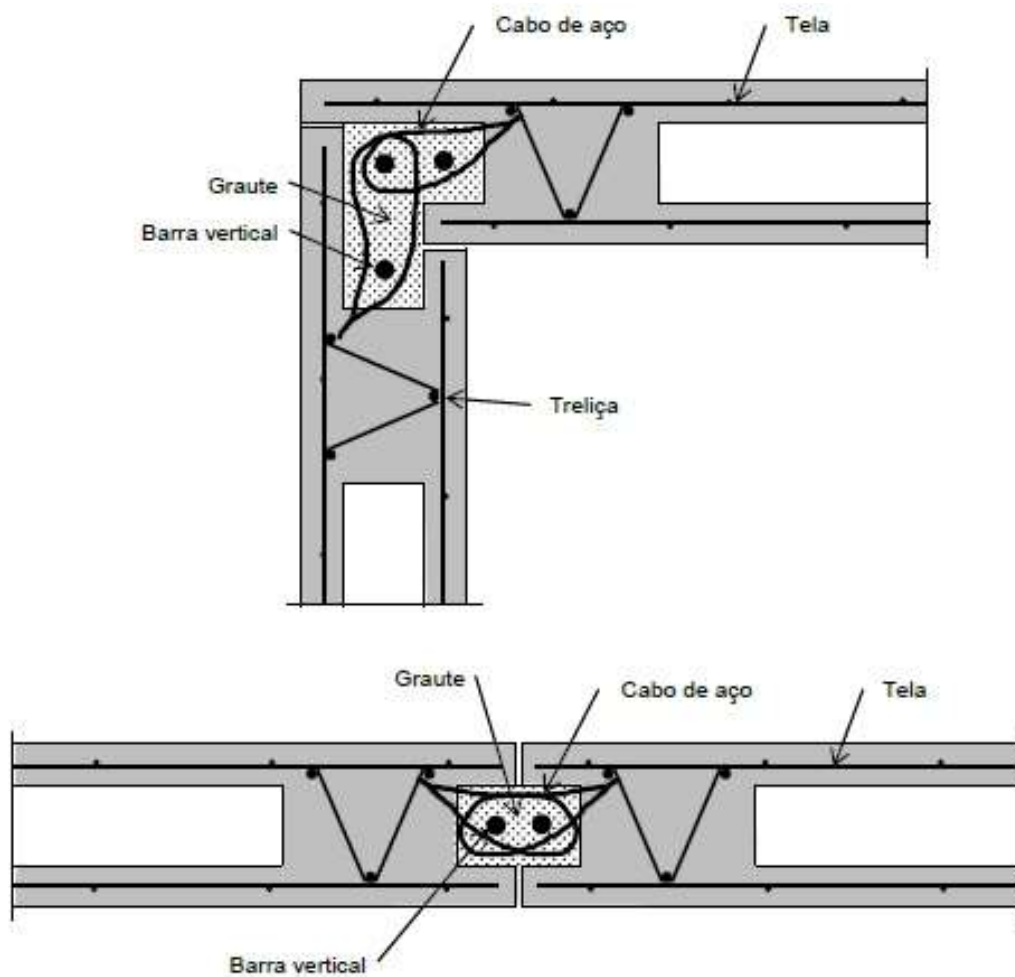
Ligação dos Painéis Estruturais da Empresa A
